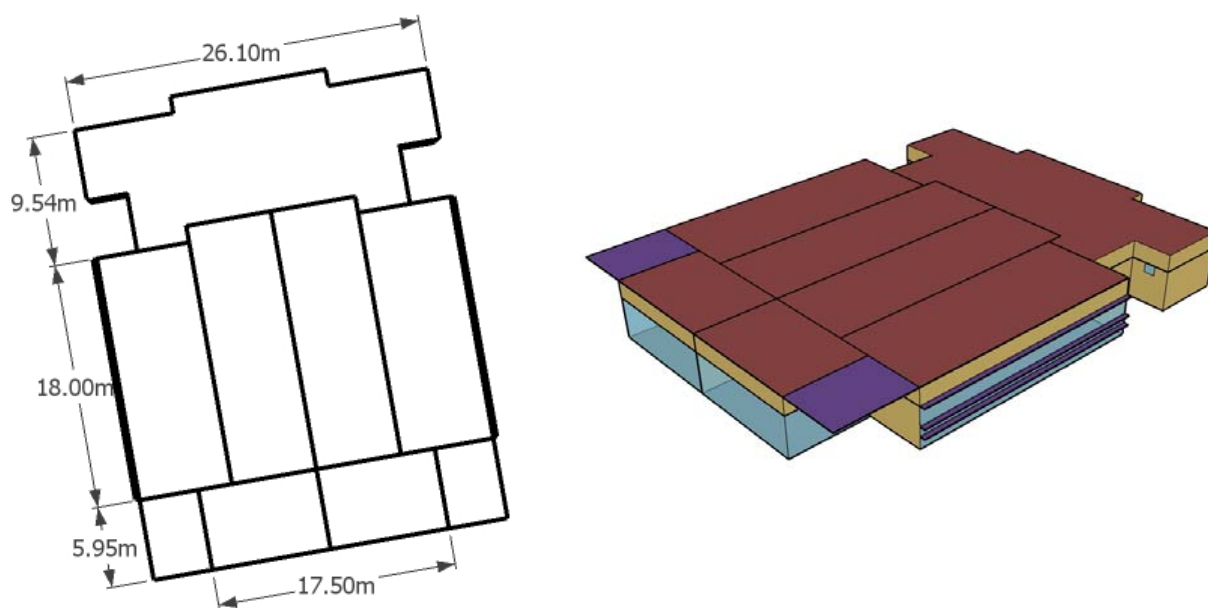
Planta e modelo espacial do pavimento tipo do Proposed Building para o estudo de caso #2
